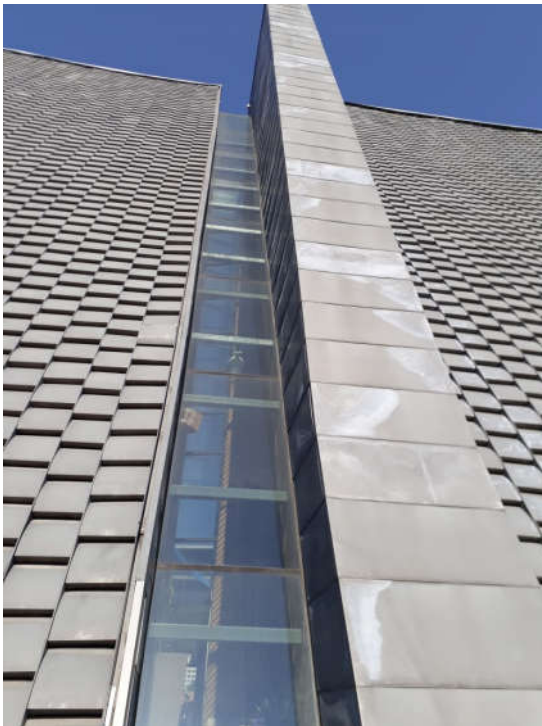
TEXTURAS DE PLACAS ZINC SISTEMA DE CUBIERTA LIGERA EN EL EXTERIOR. Elaboración propia
